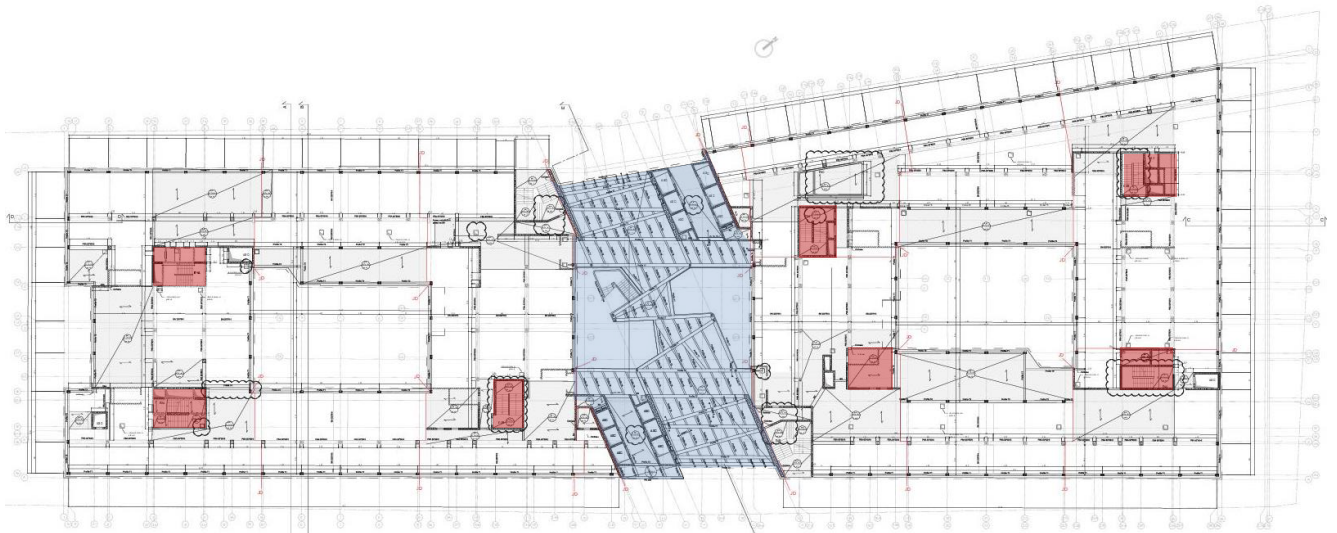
Plan PH R+3 – Localisation de l'espace central (bleu) et des noyaux structurels (rouges) // © bordas+peiro
